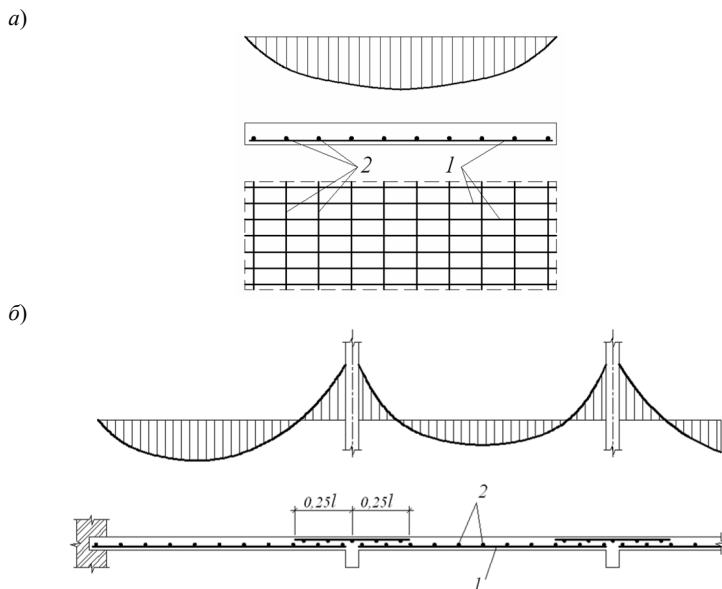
Армирование плит и эпюры моментов при равномерно распределенной нагрузке: *а* – однопролетная плита; *б* – многопролетная плита; *1* – стержни рабочей арматуры; *2* – стержни монтажной (распределительной) арматуры
